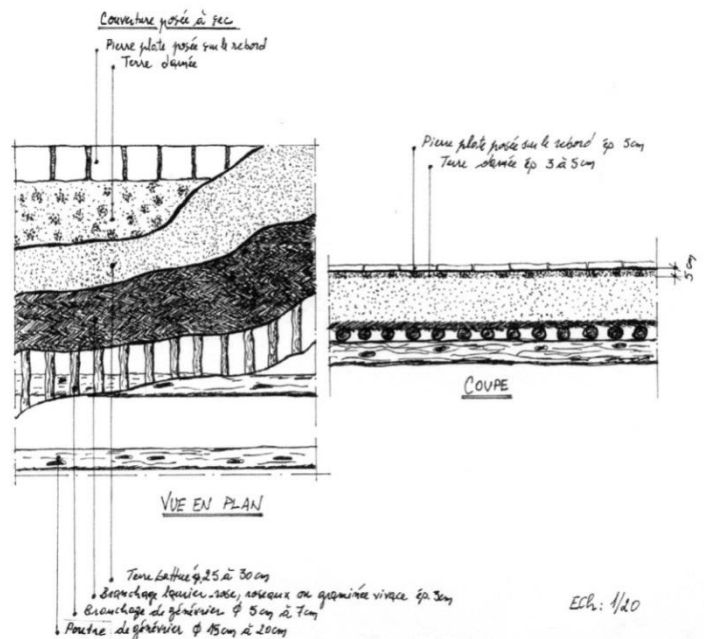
Vue en plan et coupe sur toit plat, Aurès, Algérie (Chergui Samia)
